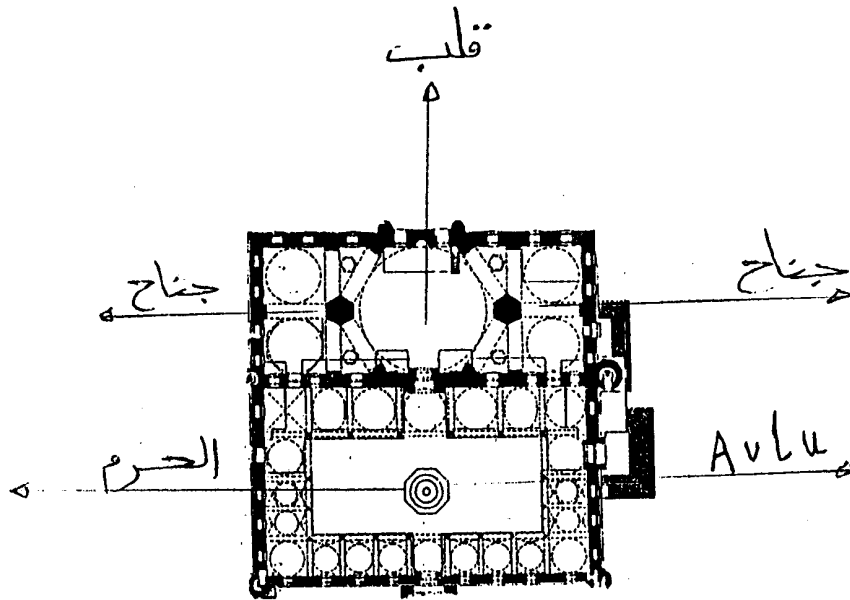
مسقط أفقي لجامع الاحمدية ببغداد
